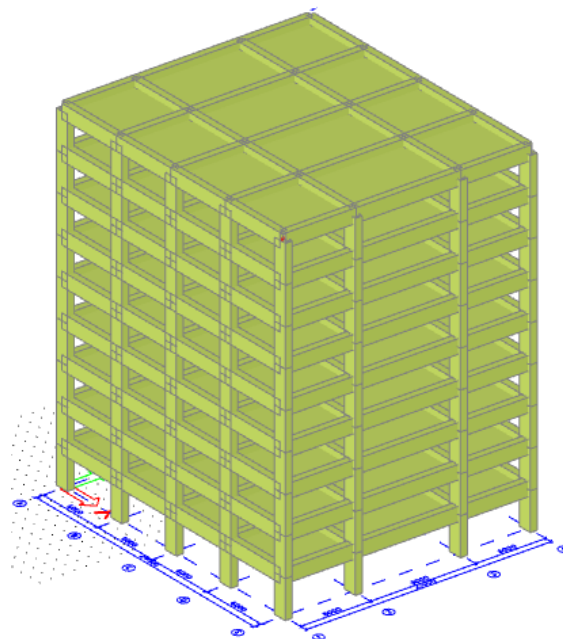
Prezentare structură 3D din beton armat cu armătură rigidă
